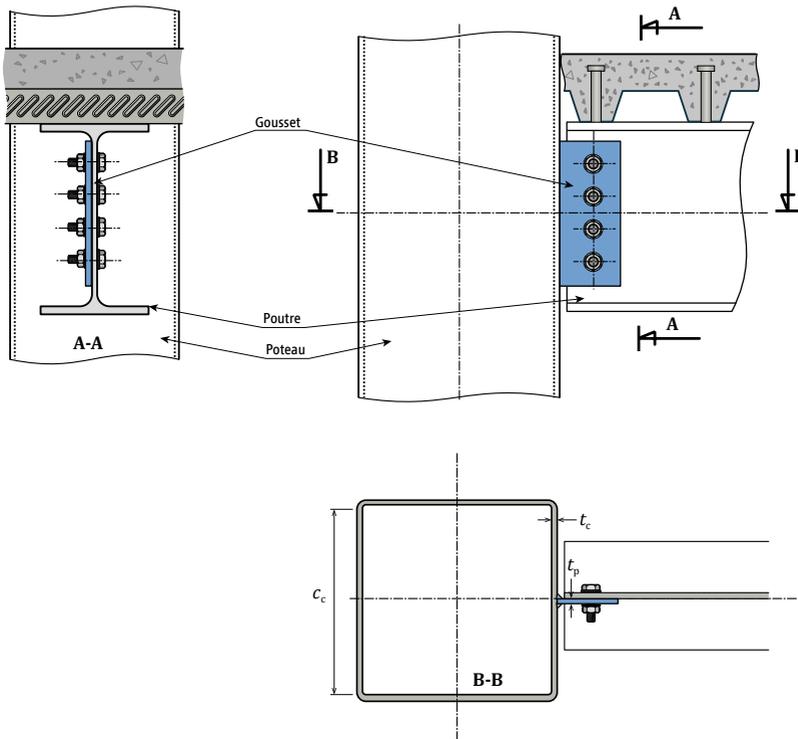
Assemblage articulé par gousset sur poteau à section creuse rectangulaire
